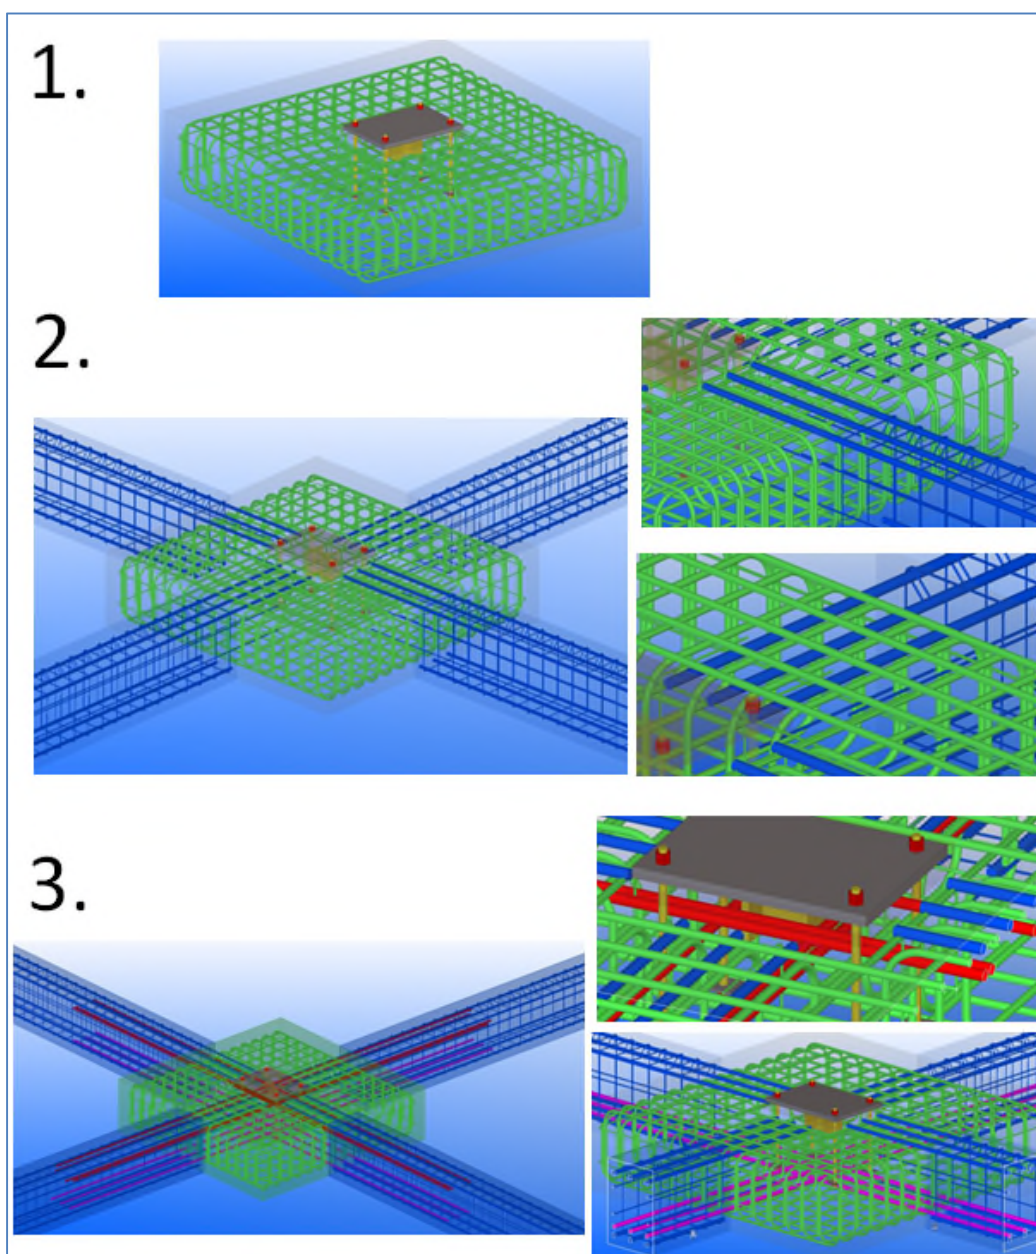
Disposición de armadura en encuentro vigas de cimentación/zapata
